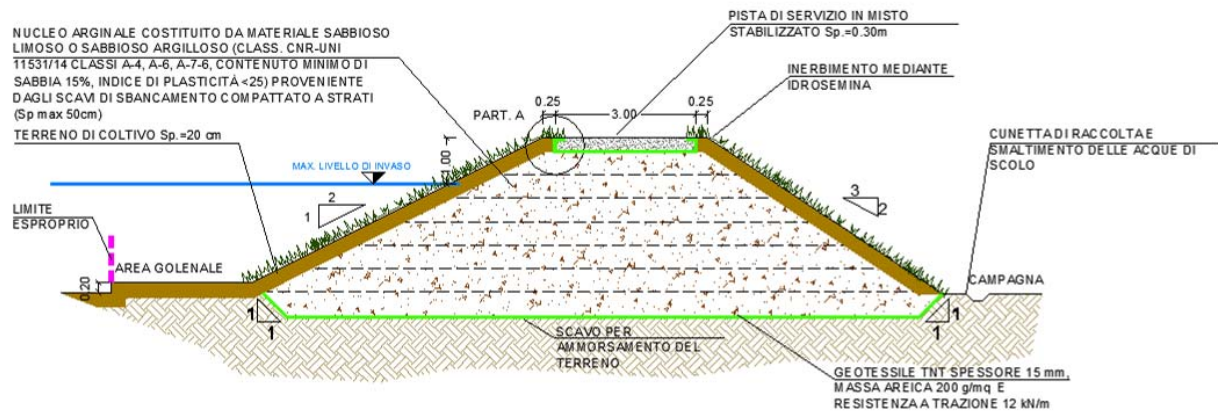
Sezione tipo di ringrosso e nuovo rilevato arginale
